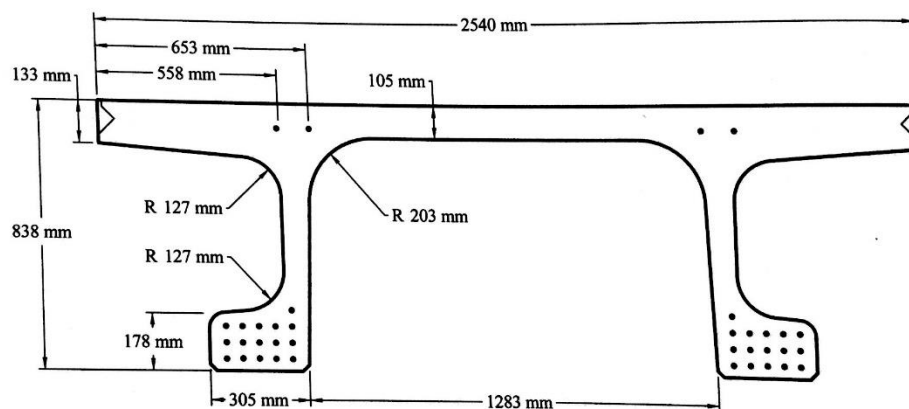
Coupe transversale d'une poutre en π (Toutlemonde & Resplendido, 2009)
